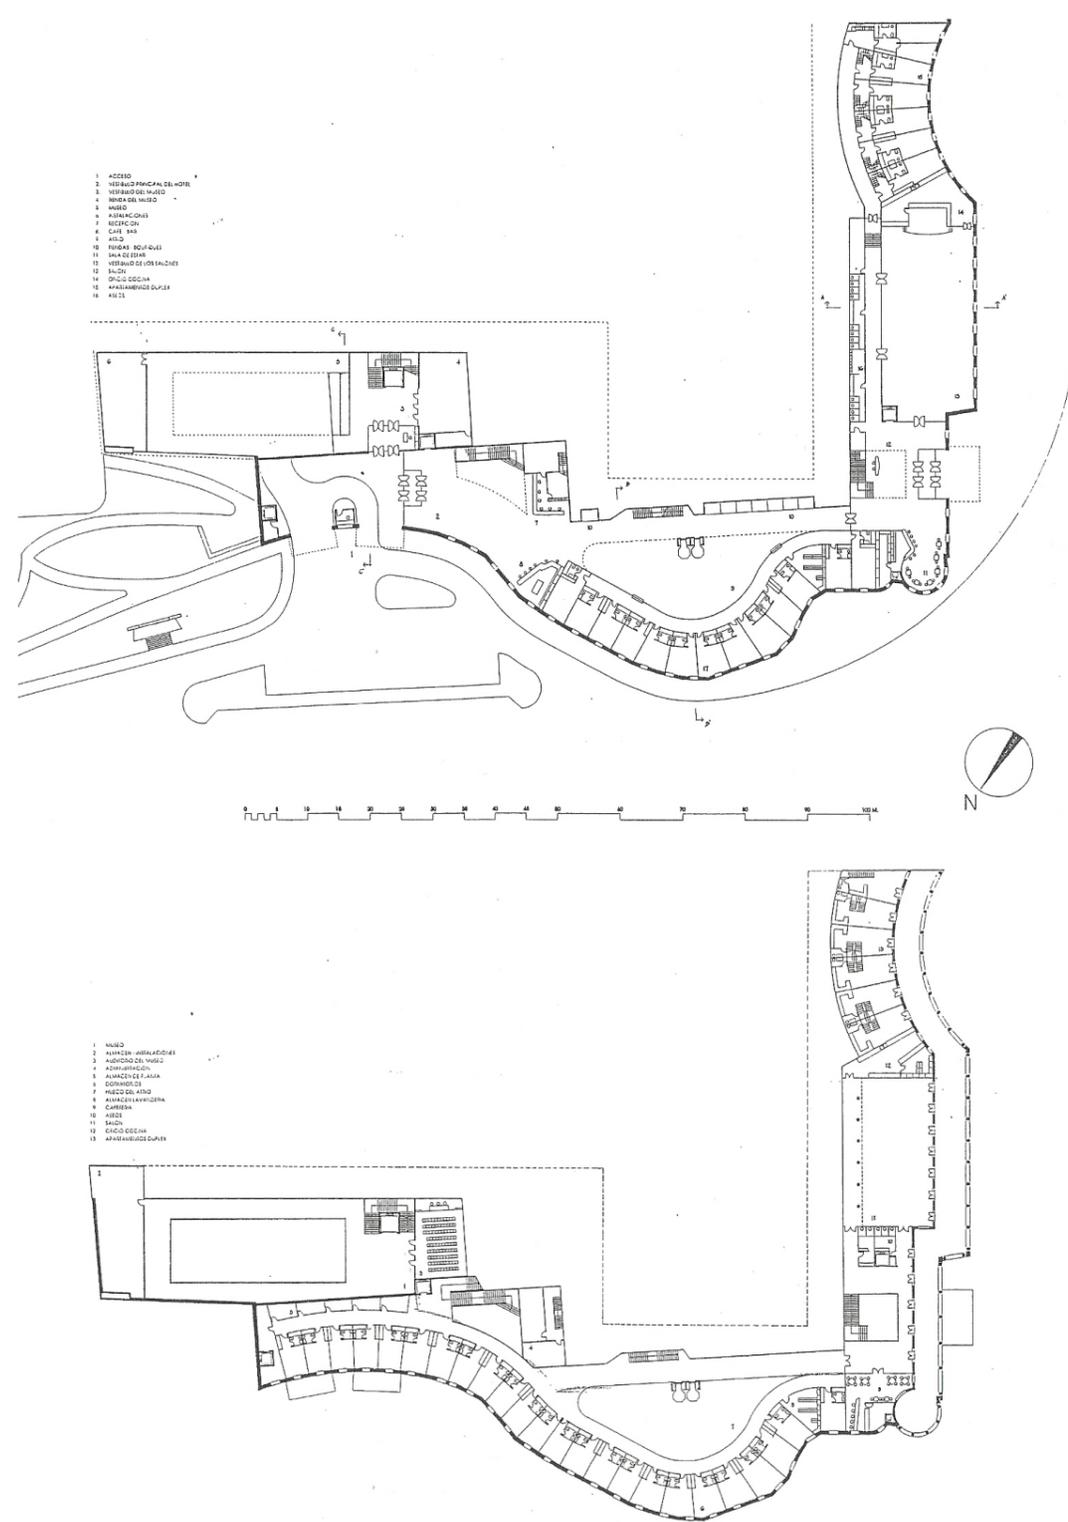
Planta baja y primera del proyecto del Gran Hotel Neguri, Archivo Municipal de Getxo.
